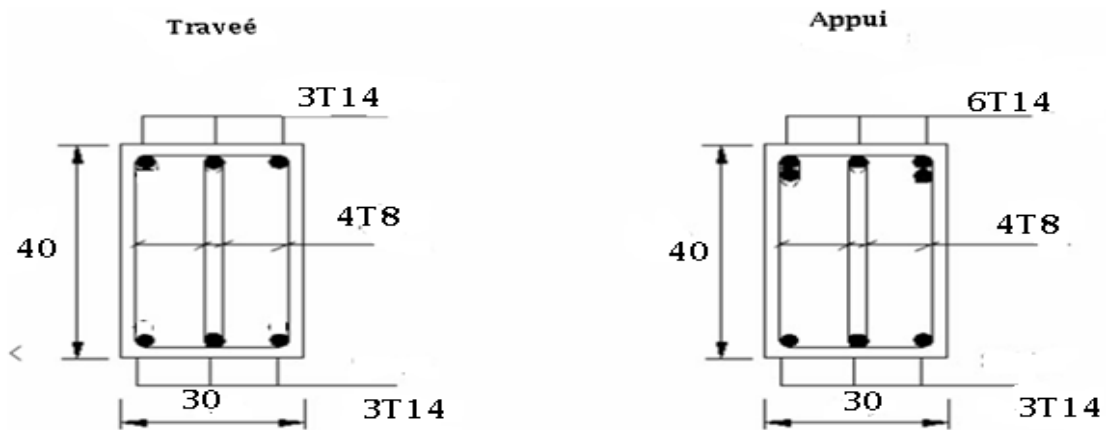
Schéma de ferrailage de la poutre palière.
